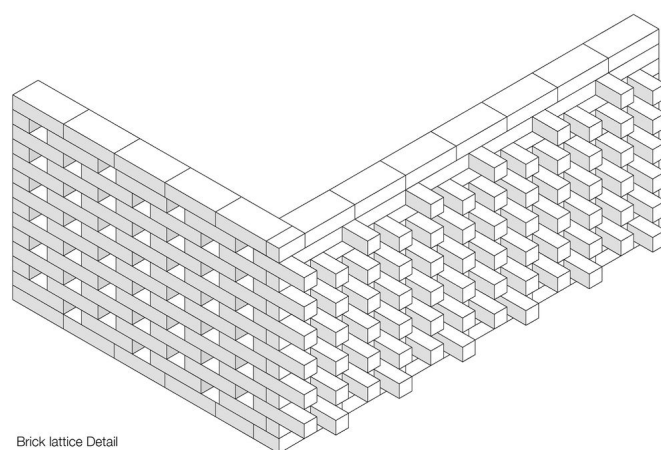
e 36 - Conjunto Volcanes: Detalhamentos Construtivos. Fonte: ArchDaily
